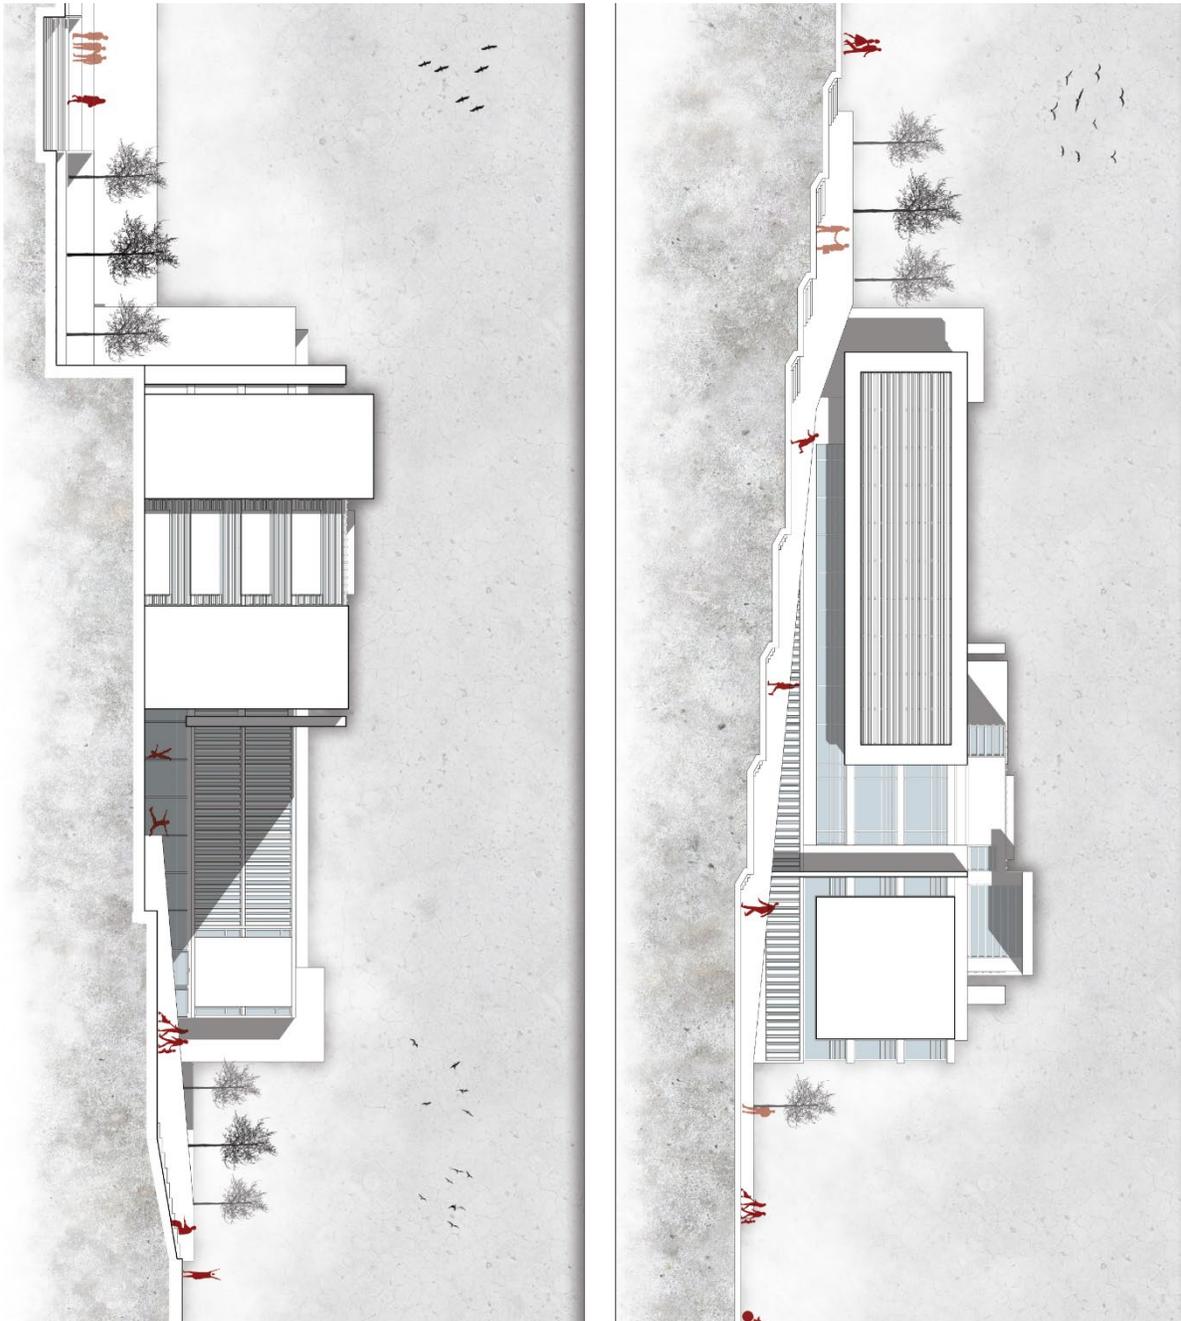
Planta Planta 5 y Planta 6. Elaboración Propia.
